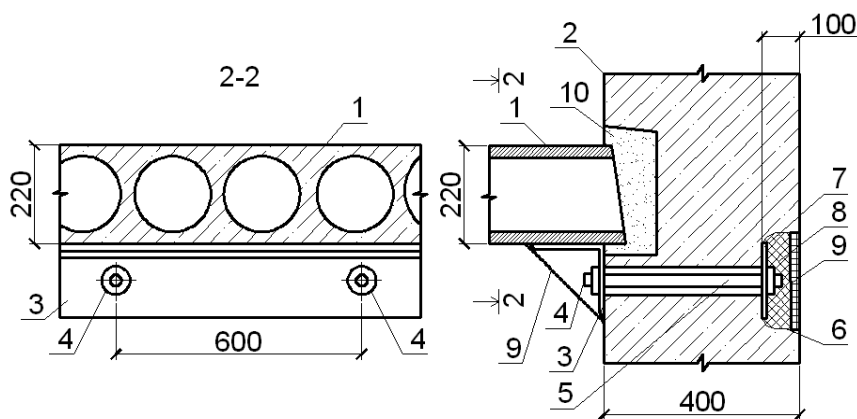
Посилення вузлів опирання плит перекриттів на зовнішні несучі стіни:
